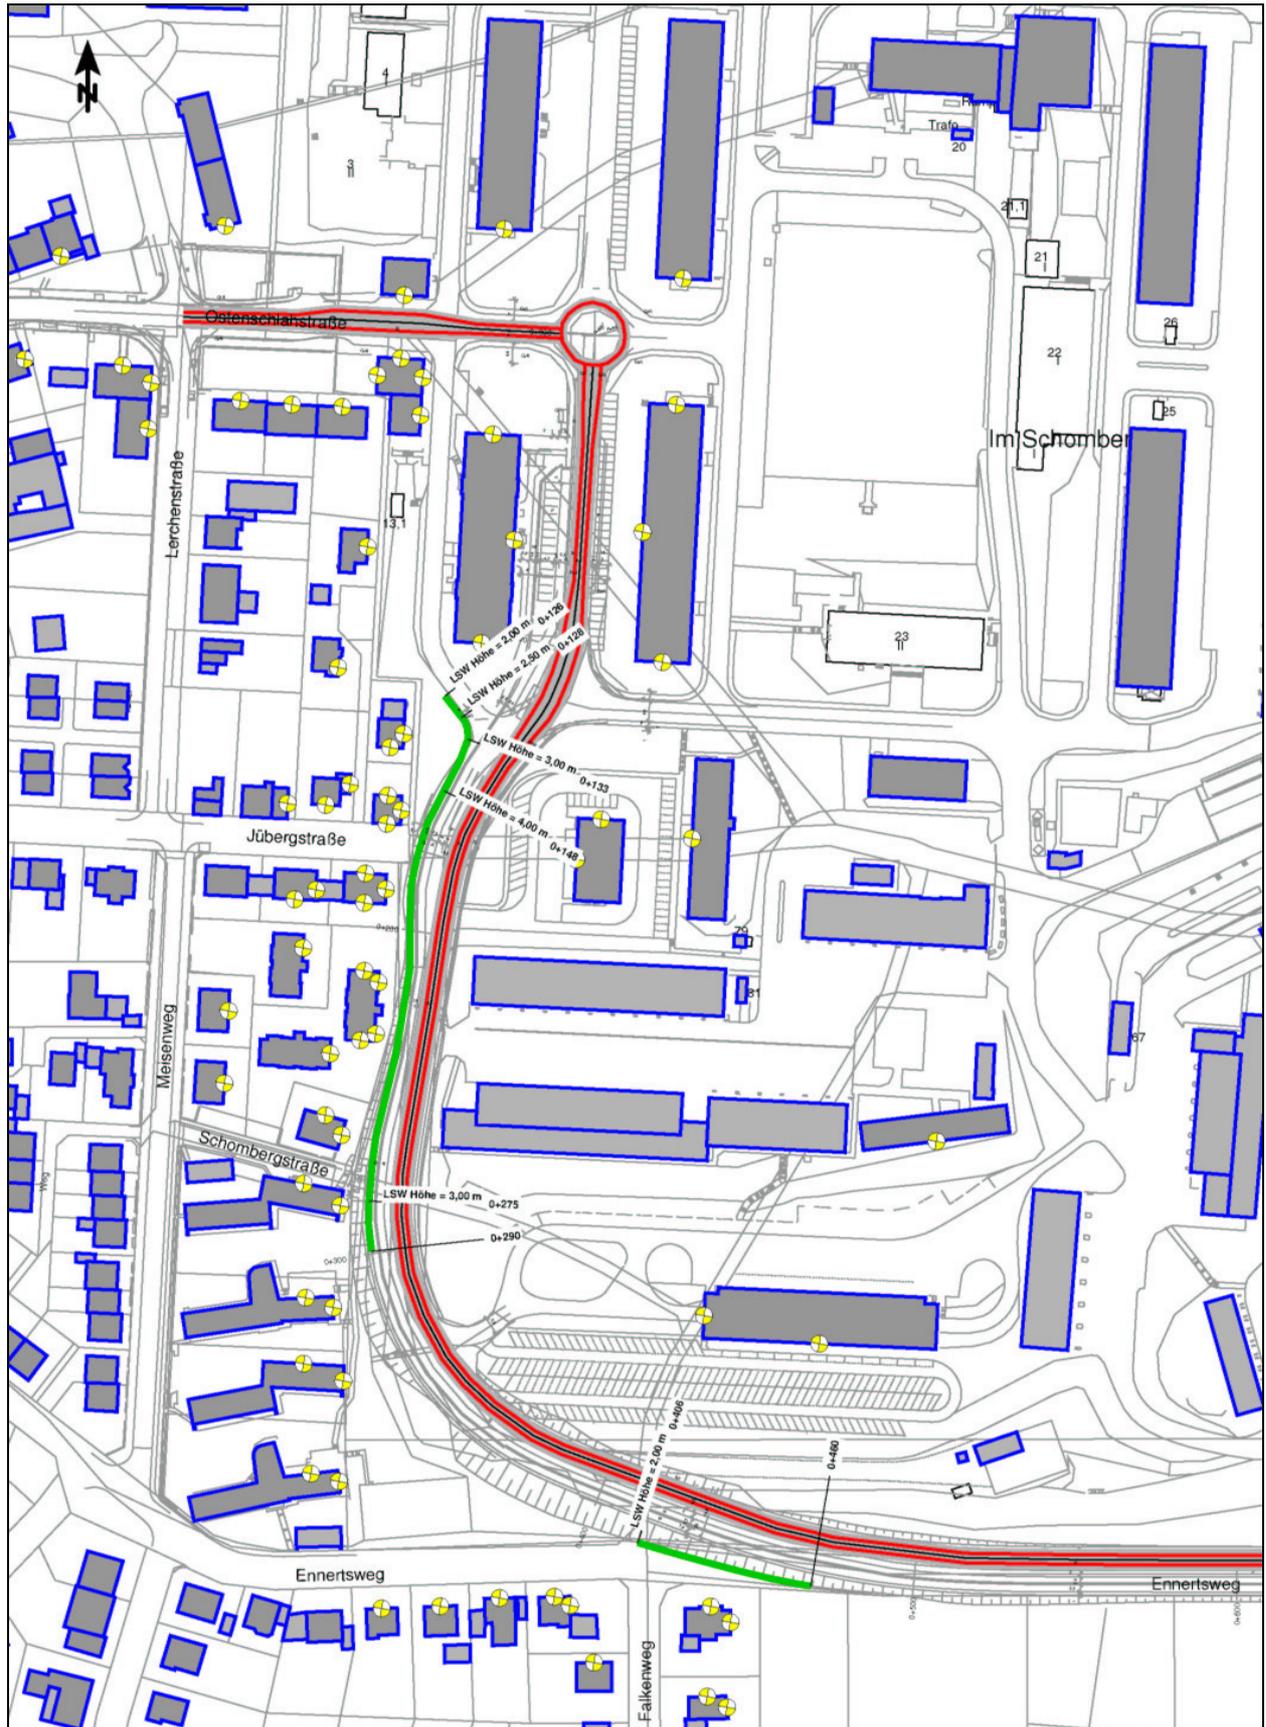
Lageplan der Verbindungsstraße mit erforderlichen aktiven Schallschutzmaßnahmen
